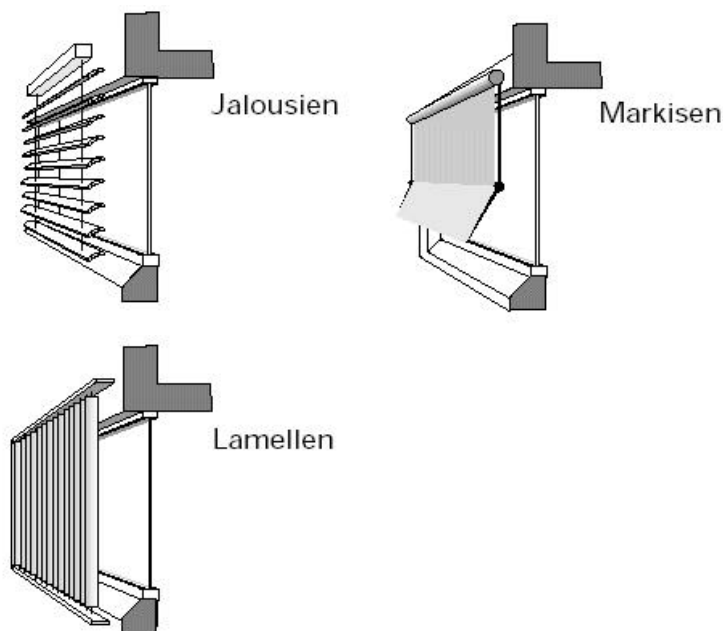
Außen liegende Sonnenschutzsysteme¹³
